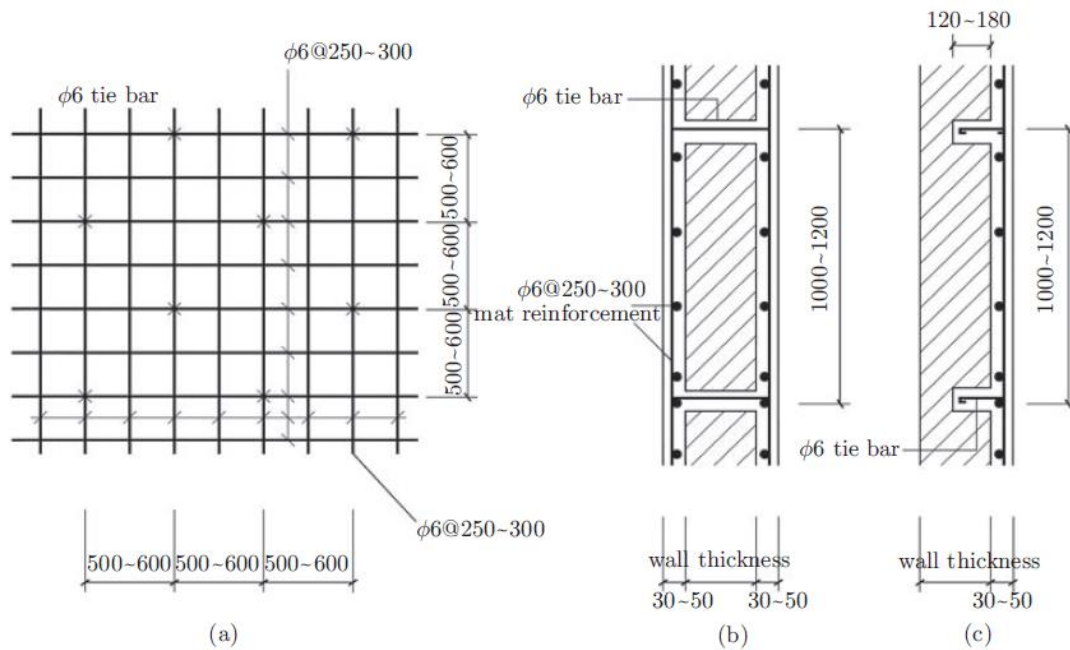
Reforzamiento de muros de mampostería. Fuente: Retrofitting Design of Building Structures, Xilin Lu (2010).
